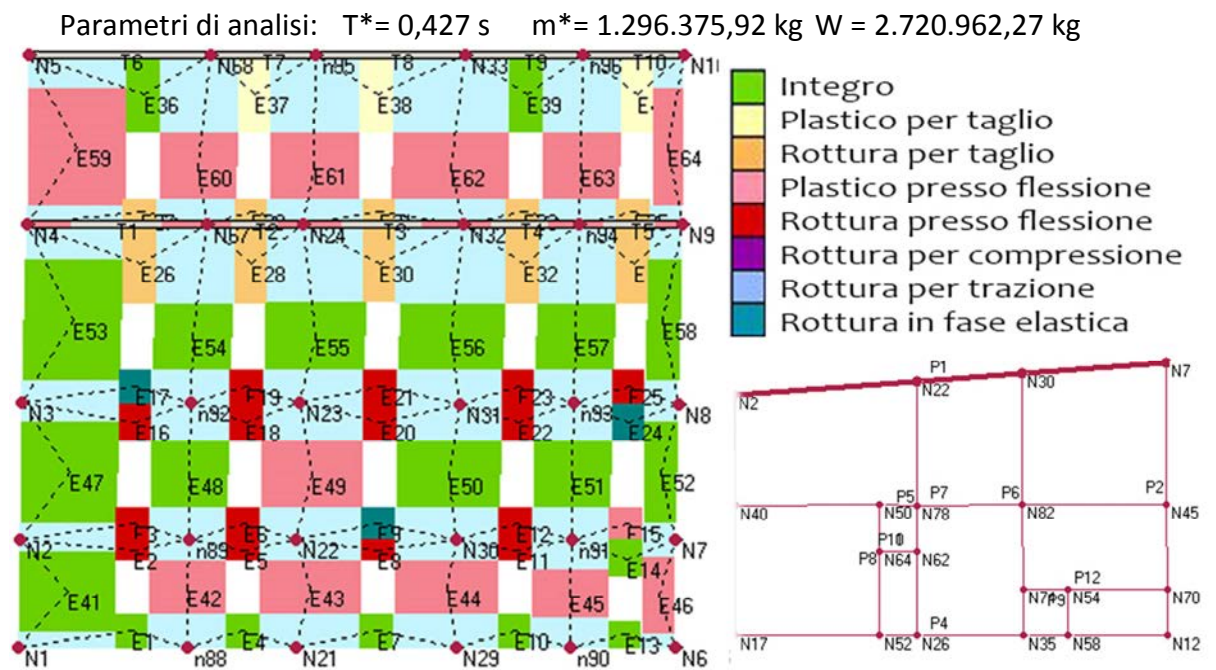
Dettagli dell'analisi 11: configurazione finale della parete 1 deformata all'ultimo step dell'analisi e corrispondente localizzazione in pianta al secondo livello.
